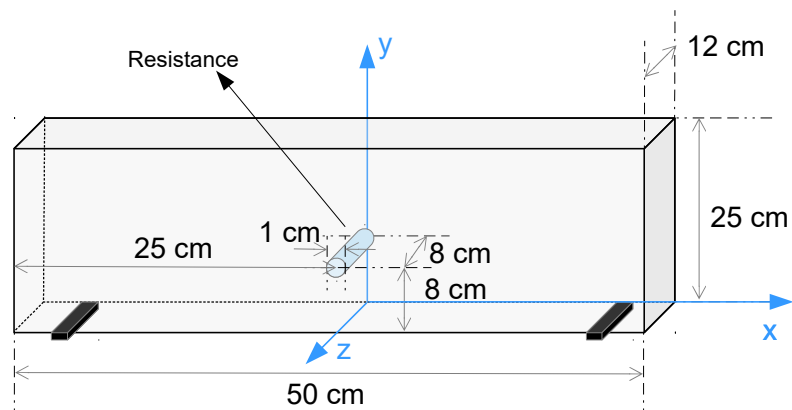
Schéma et dimensions des poutres p1-4 et p1-5 pour les essais d'endommagement thermique.
